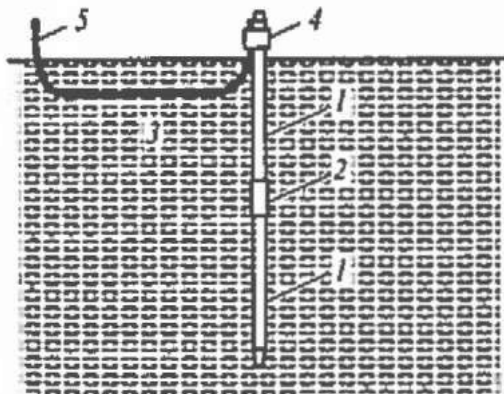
Пример вертикального заземлителя с соединительной муфтой:
